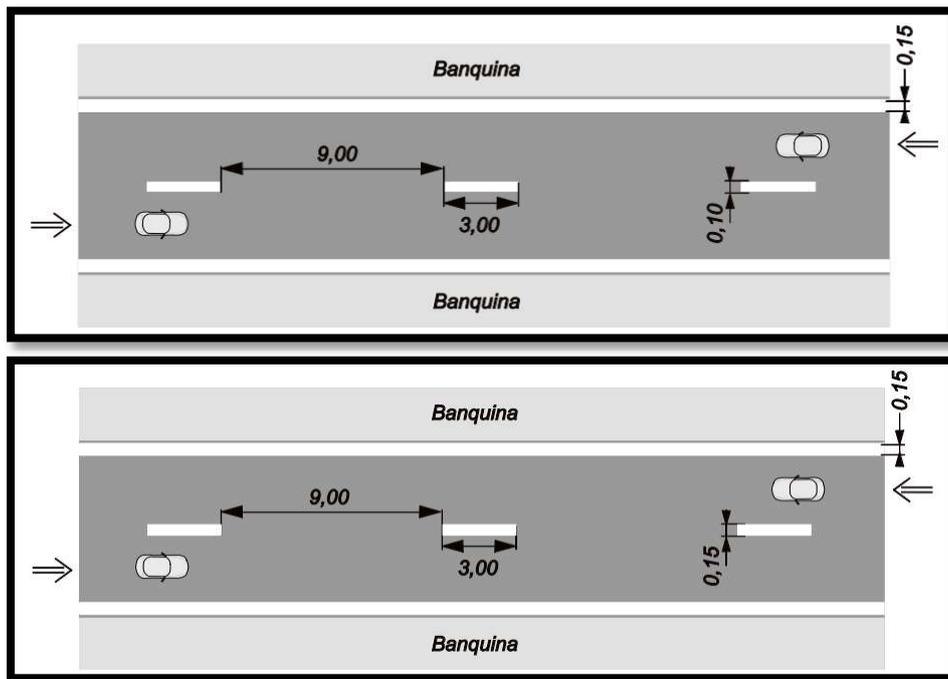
Demarcación de líneas longitudinales para calzadas de ancho mayor a 7,30 m.
